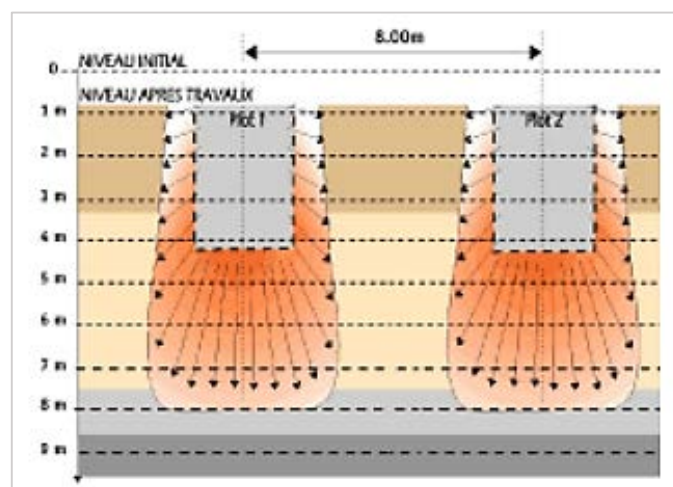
25 : Plots ballastés – exemple de coupe type.
